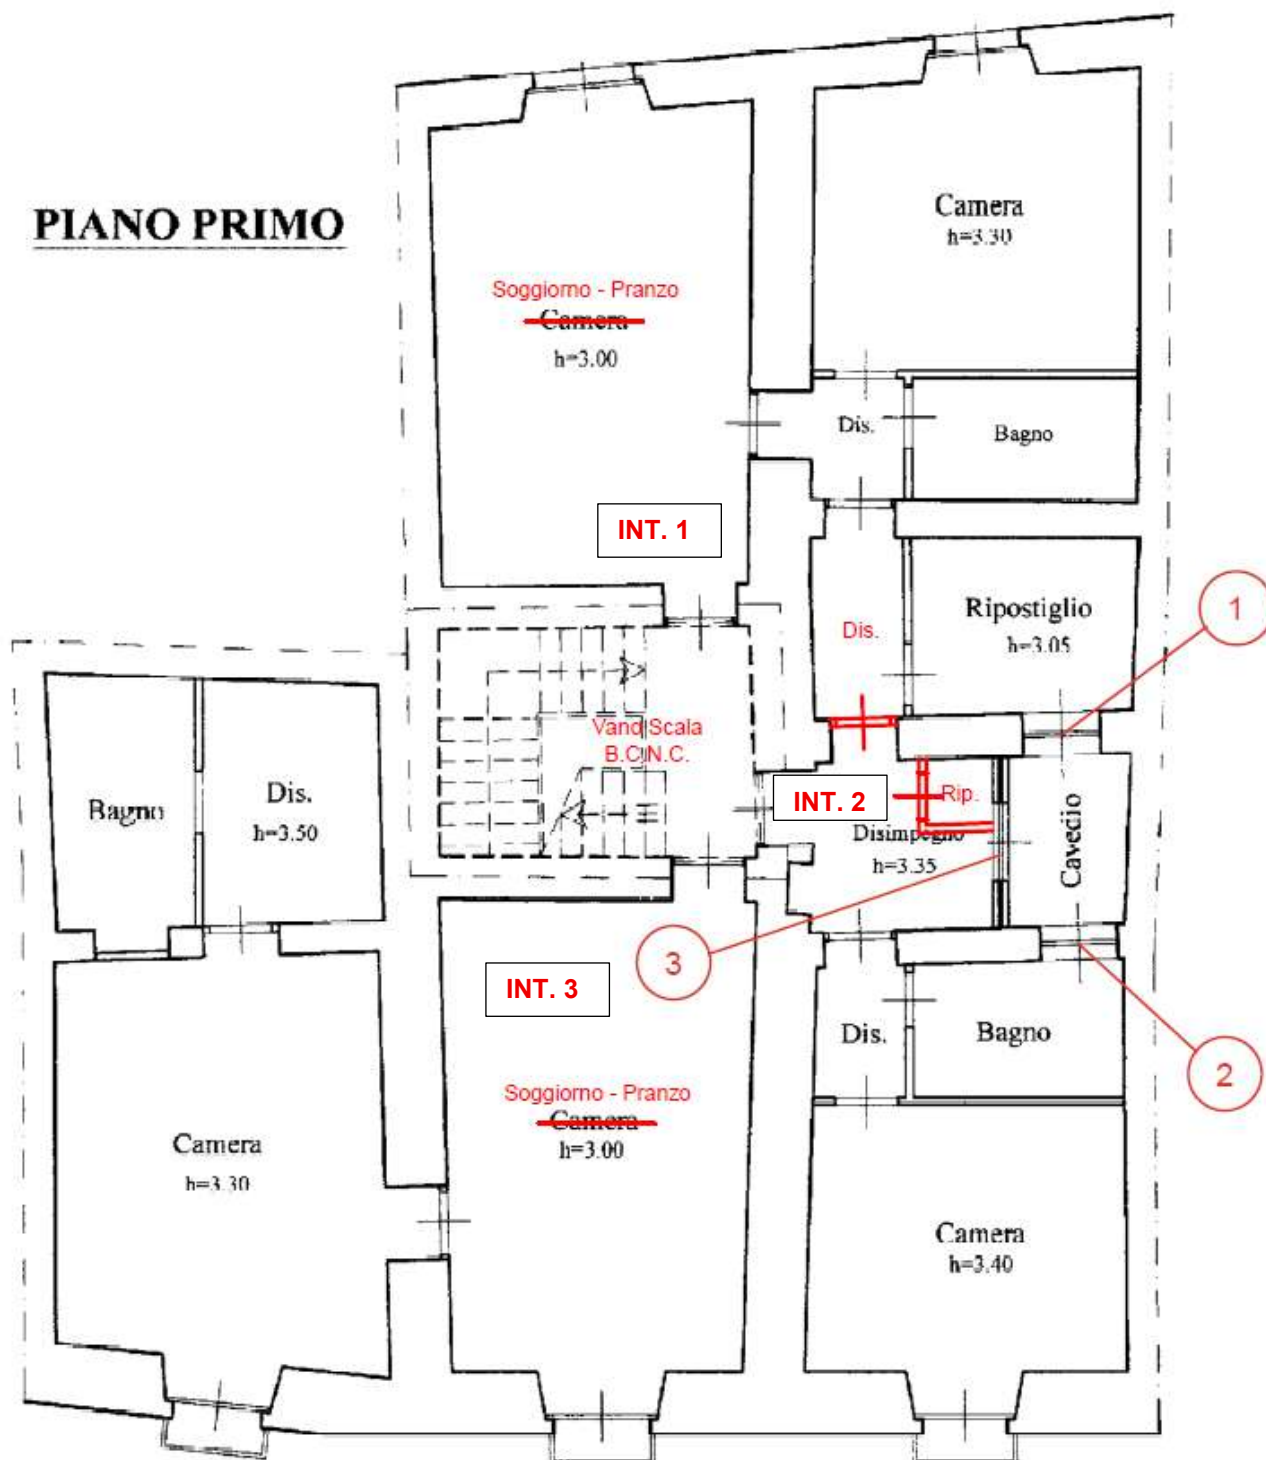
Lotto 2, stralcio della planimetria catastale in atti (fuori scala) del primo piano con individuazione delle difformità
